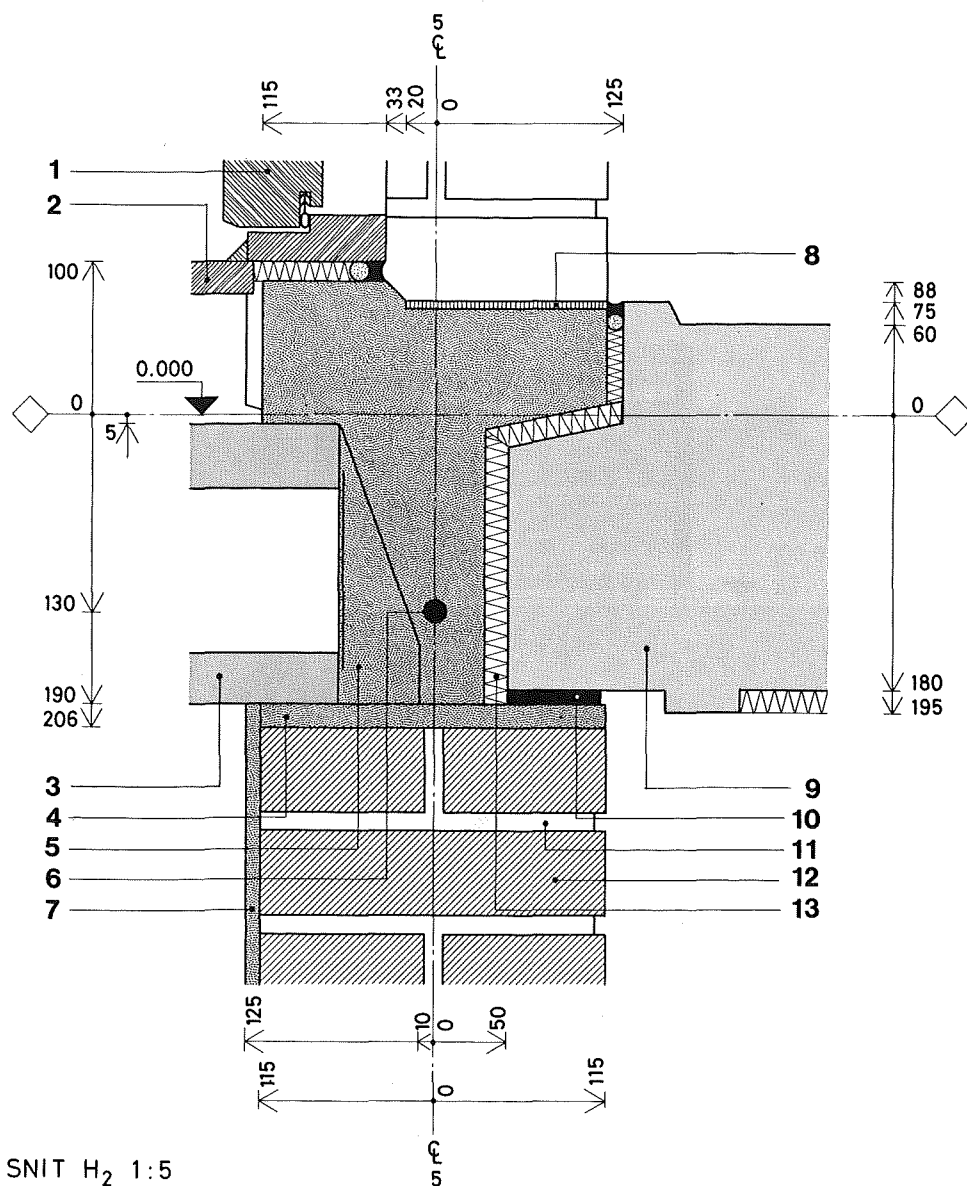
viser lodret snit i den afstivende 1 stens længdevæg. Samlingen er udført med en excentrisk placering af det normale dækelement til højre i figuren; mens venstre dækelement er afskåret for at give plads til den viste udstøbning med beton 15 mellem dækkomponenterne. Herved sikres en god kraftoverføring fra den overliggende væg gennem udstøbningen til den underliggende. Væggen er, som tidligere omtalt, en del af bygningens længdeafstivende hovedsystem. Horisontale detailmål er afsat udfra væggenes symmetrilinie, mens højdemål afsættes udfra rådækmodulplanet.
